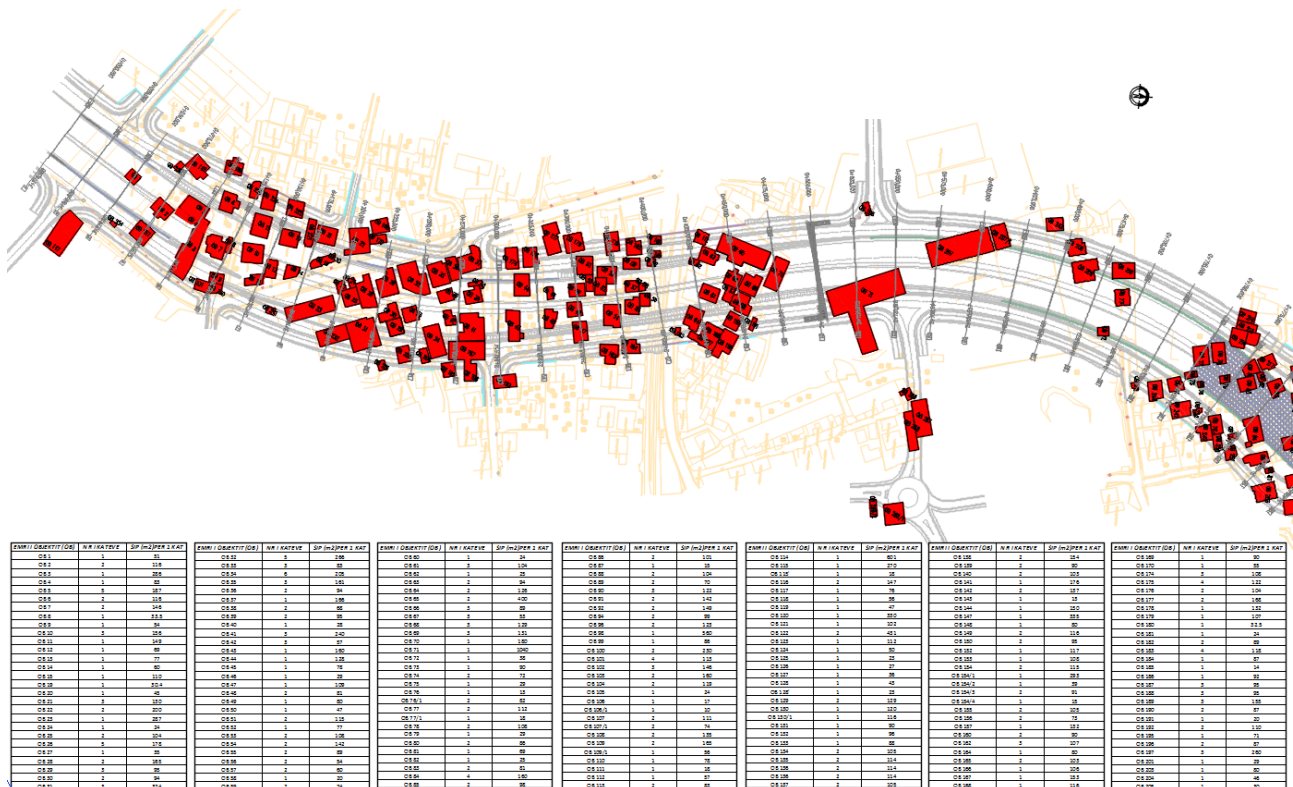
Fragment nga Planimetria e Nderhyrjeve
